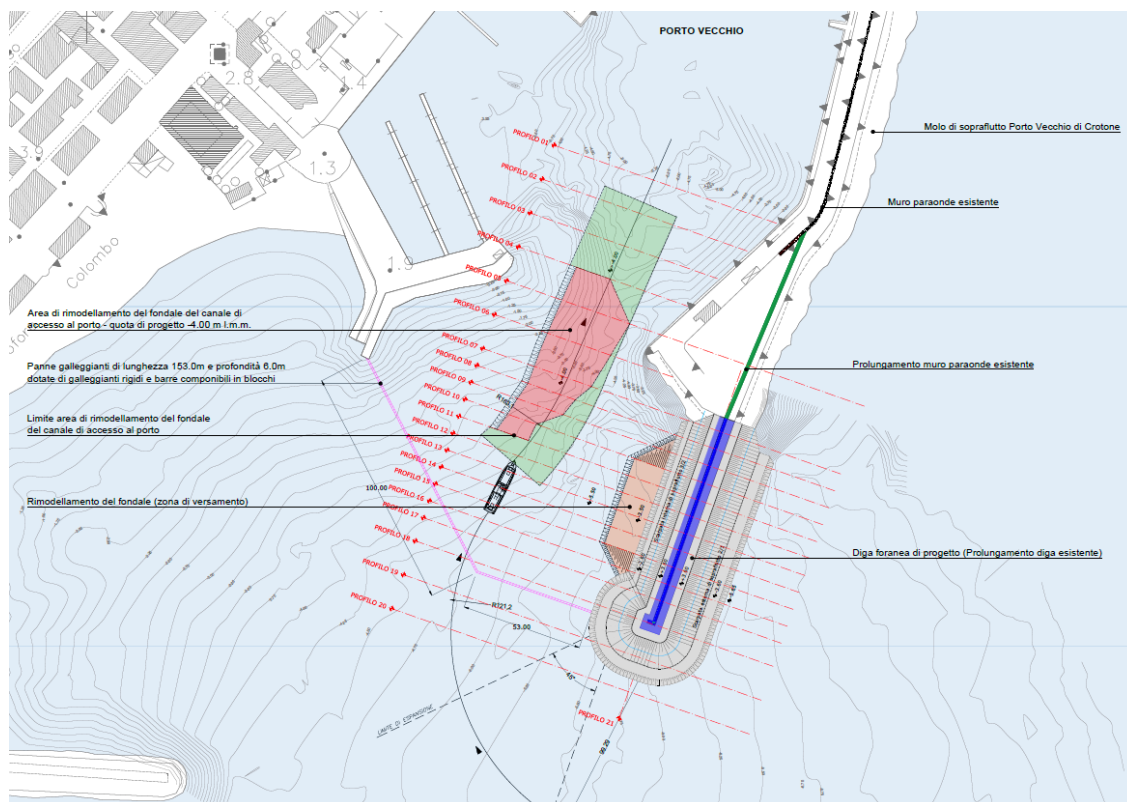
Planimetria di progetto di rimodellamento dei fondali
